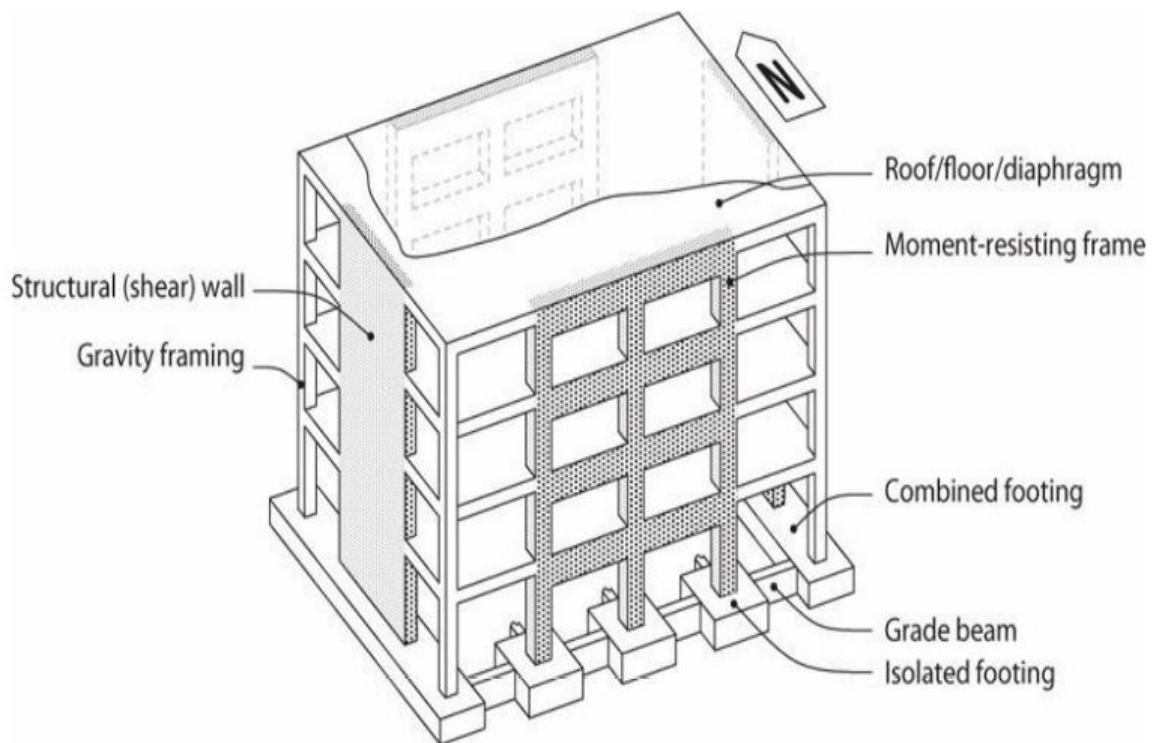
Elementos típicos para un sistema estructural de concreto reforzado. (Moehle, 2015)
